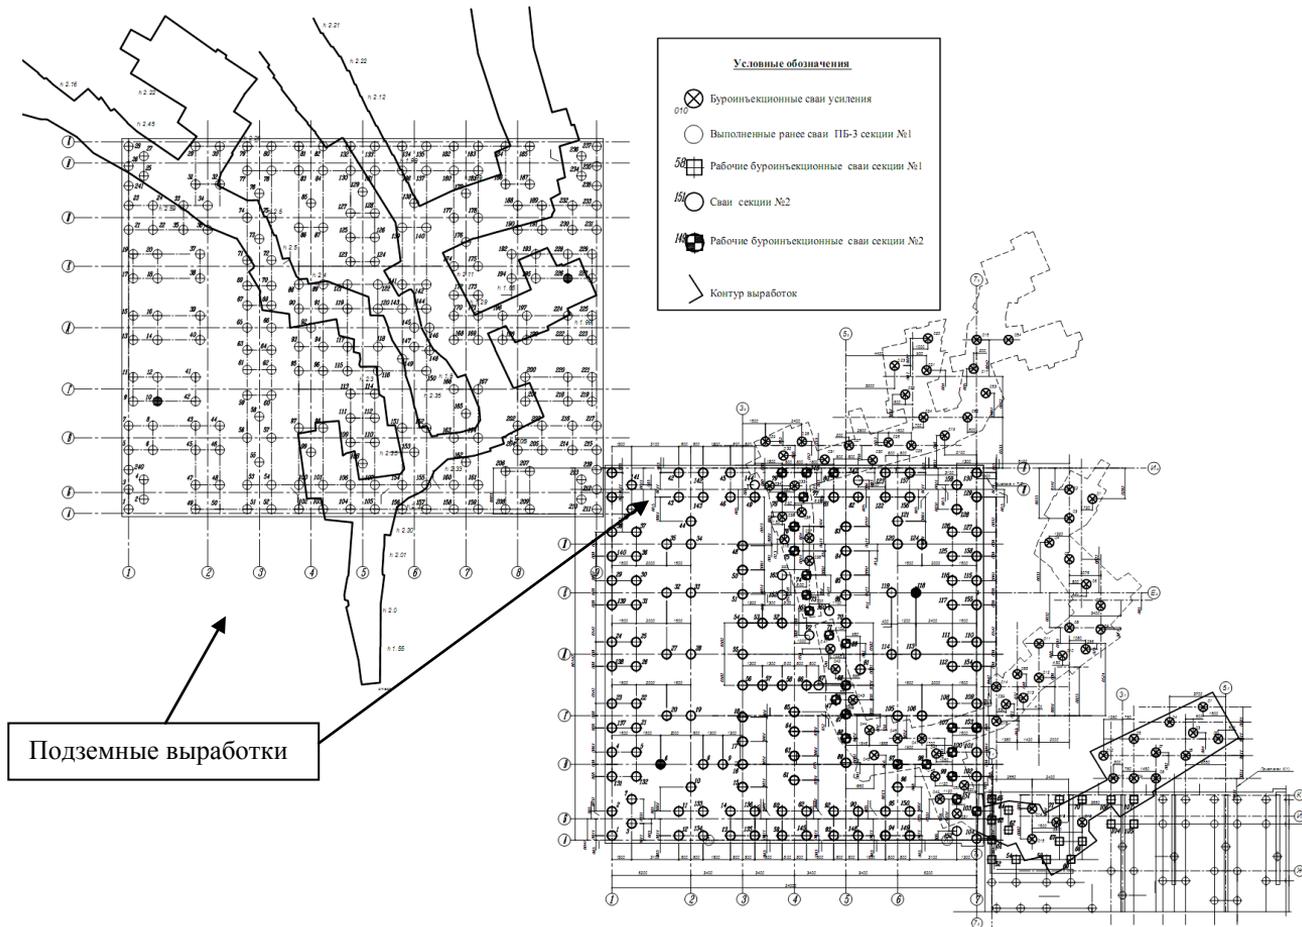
Схема расположения выработок и свайного поля (укрепление выработок в районе 3-й секции условно не показано)
